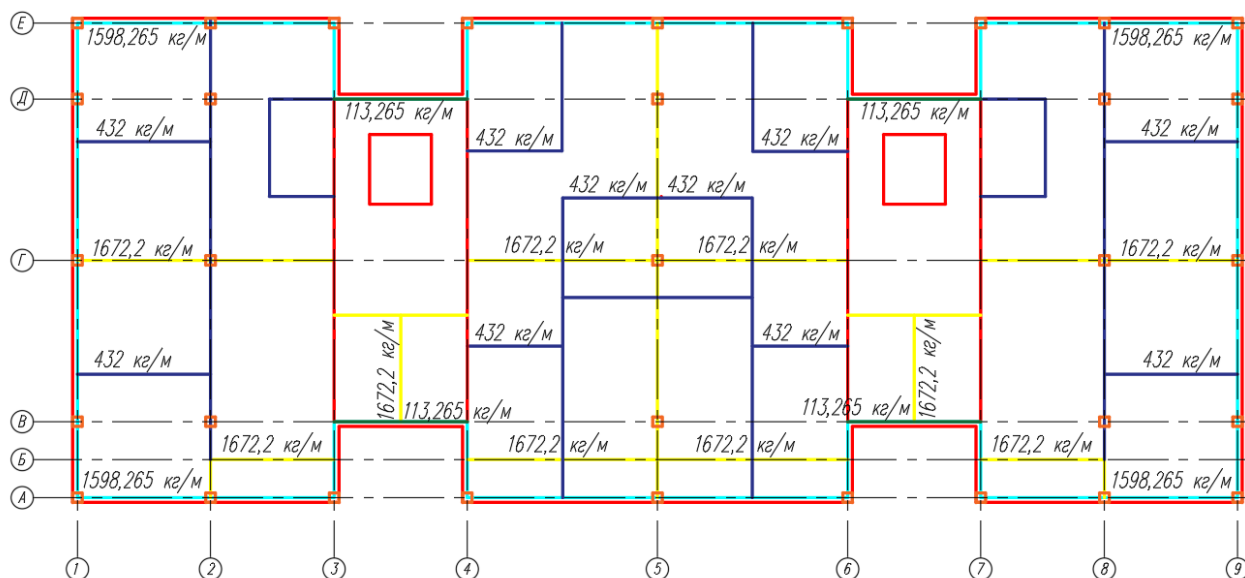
Схема приложения нагрузок от стен и перегородок, кг/м
